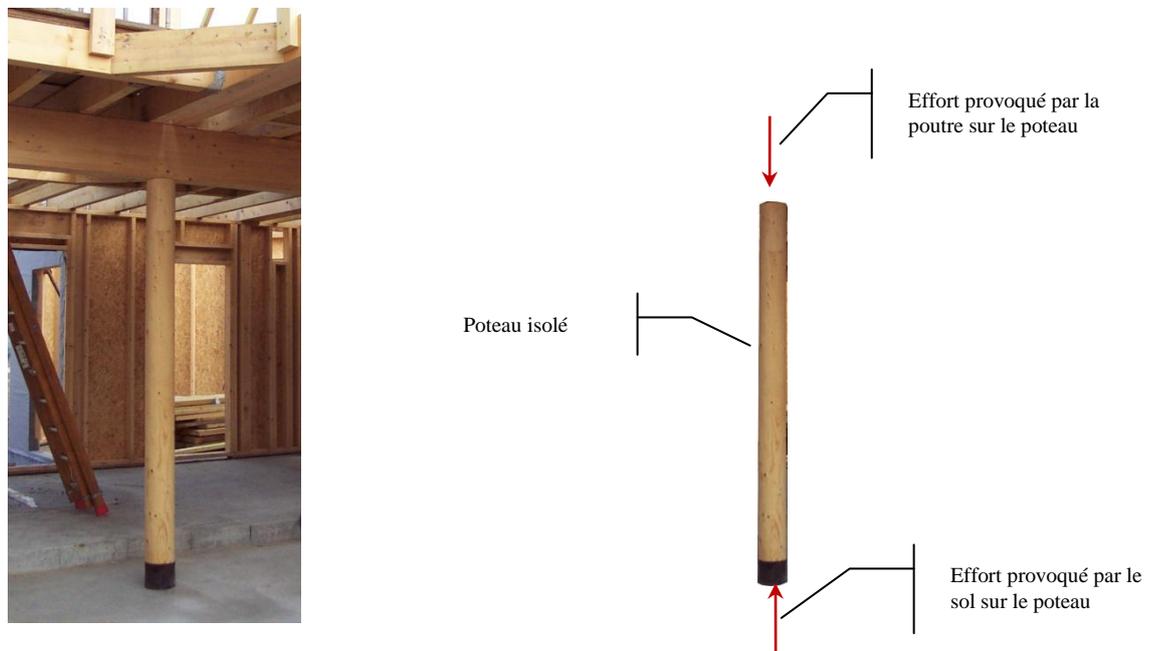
poteau isolé (@ MBC (Maison Bois Cruard))
